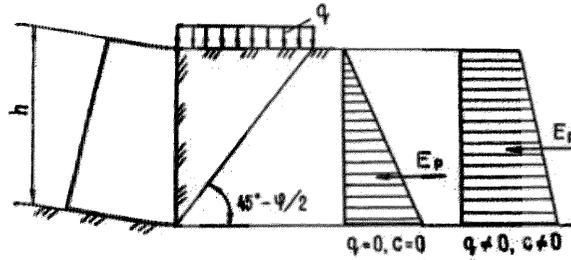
Схема к расчету пассивного давления грунта на вертикальную гладкую стенку
